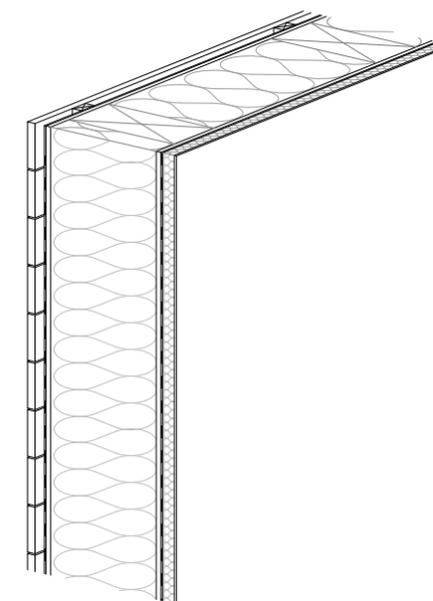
Aufbauten Holzständerbauweise und Holzmassivbauweise, eigene Darstellung,
